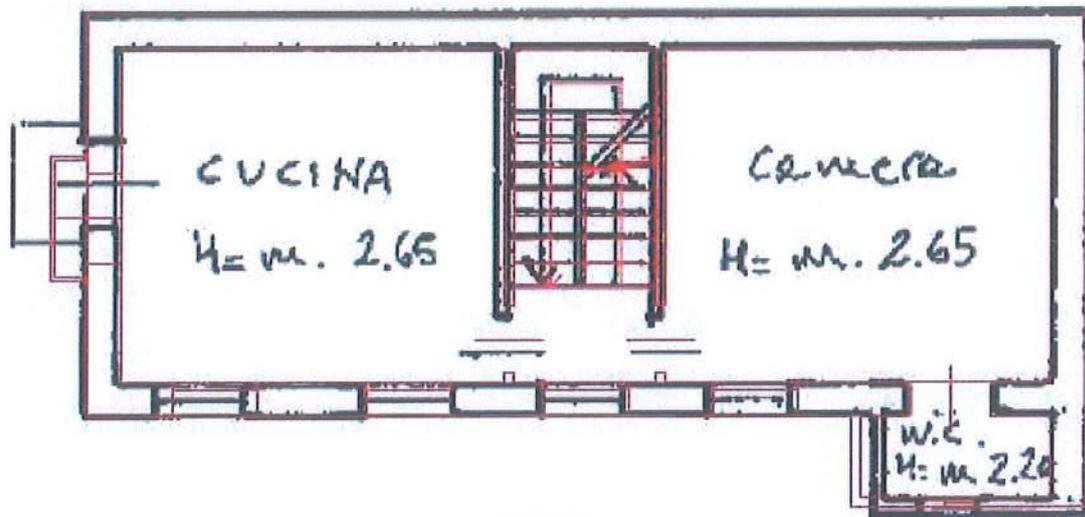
Sovrapposizione planimetria catastale – stato attuale – sub. 2 (CI).
